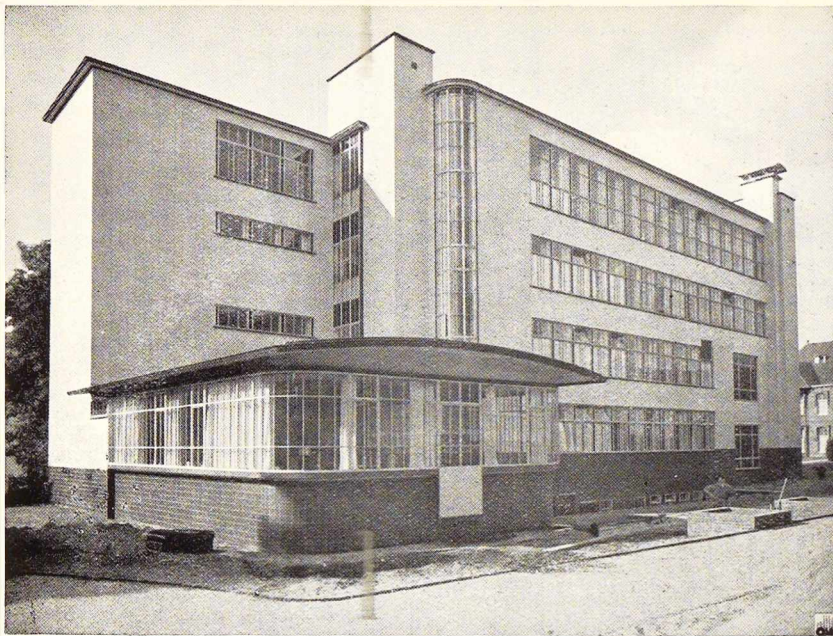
Vue de la façade arrière. A l'avant-plan, l'annexe destinée à la comptabilité mécanique.
